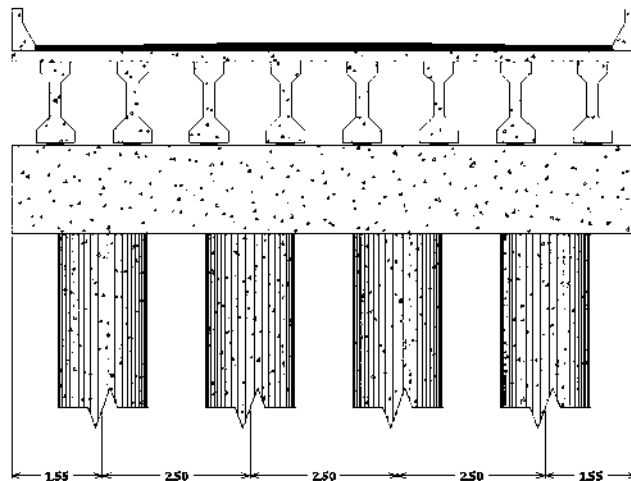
Espaciamiento entre columnas en pilas con altura $h = 20\text{ m}$ (acotación en metros)
